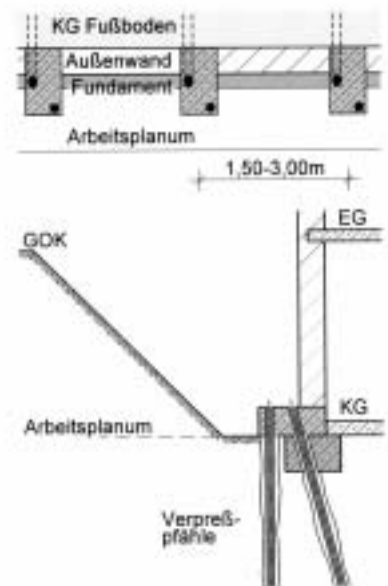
Nachgründung mit kurzem Fundamentbalken, Anordnung außen
